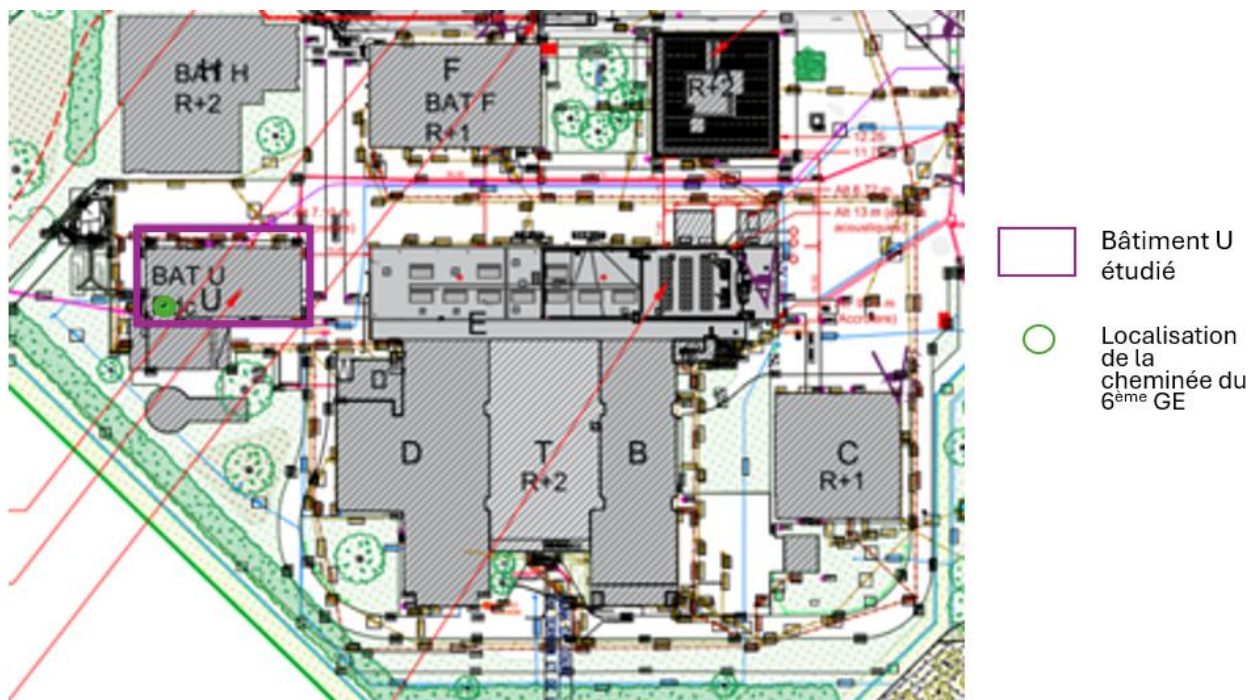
Zoom du plan de masse sur la zone du bâtiment U
